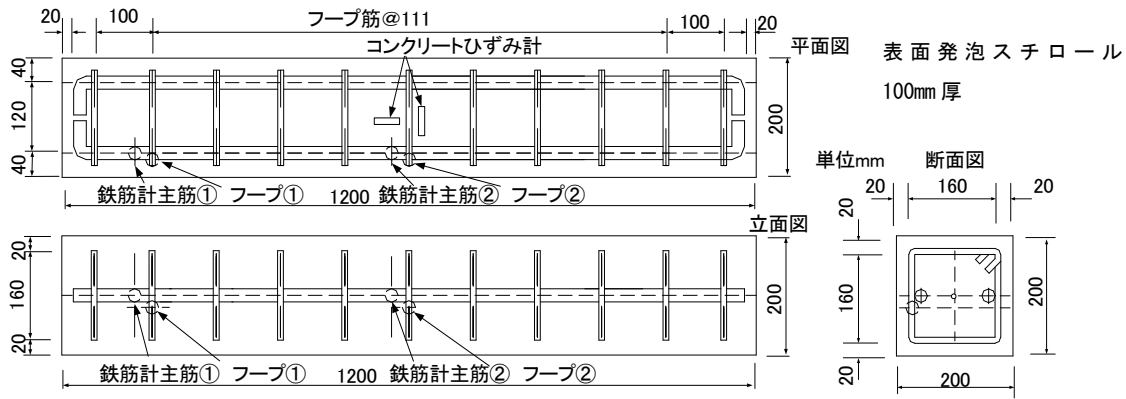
RC試験体と計測器位置 No. 1, No. 2 試験体
